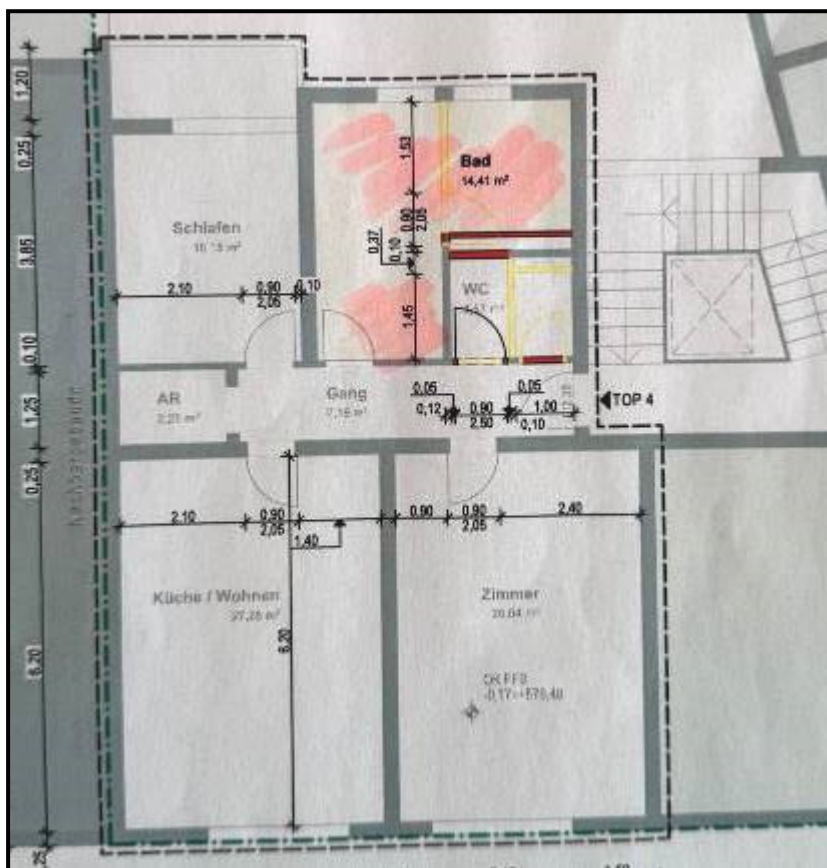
Grundrissplan Wohnung Top W 4 - Umbauplan
